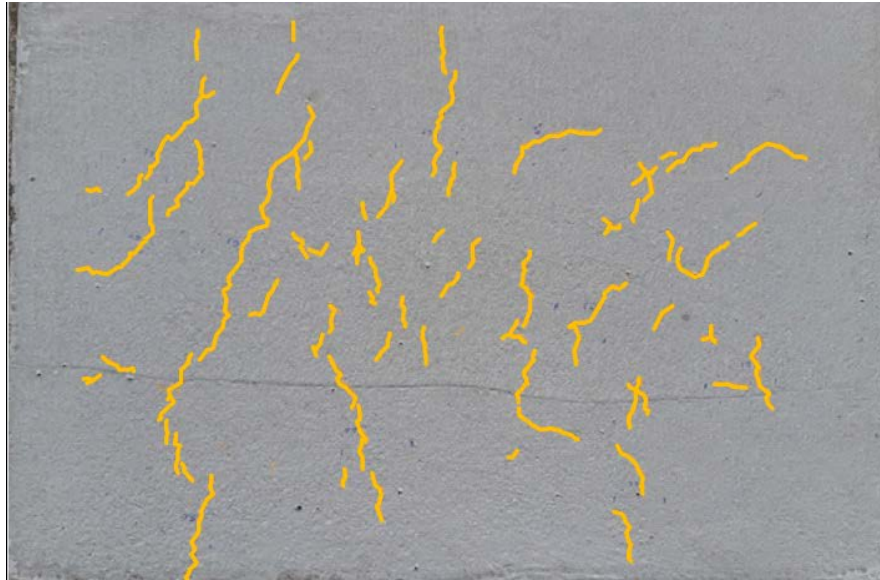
Placa sin adición de fibra de palma, con fisuras después de 6h
